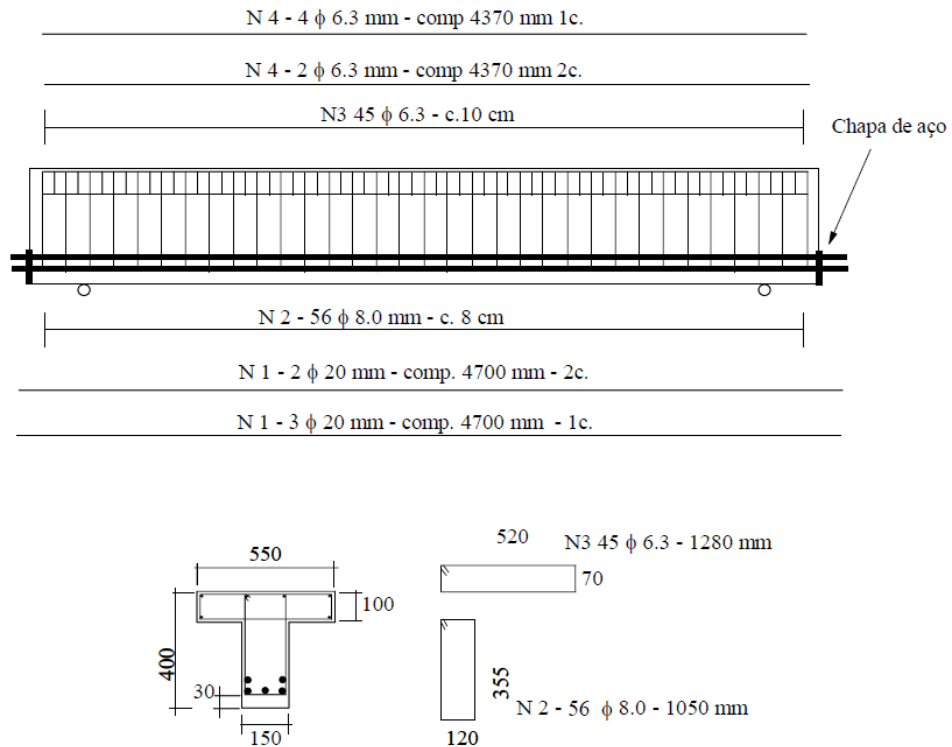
Detalhe das dimensões e armadura das vigas da série II (Castro, 2004)
